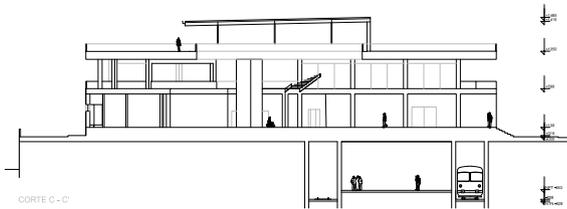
Corte (1) este-oeste, Complejo Cultural Bellavista
